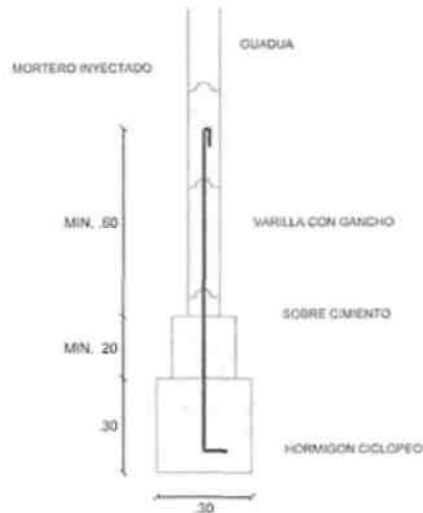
Unión pie-derecho a cemento, en muros de bahareque sin soleras de madera. (Ministerio de la vivienda, construcción y saneamiento del Perú, 2012)
